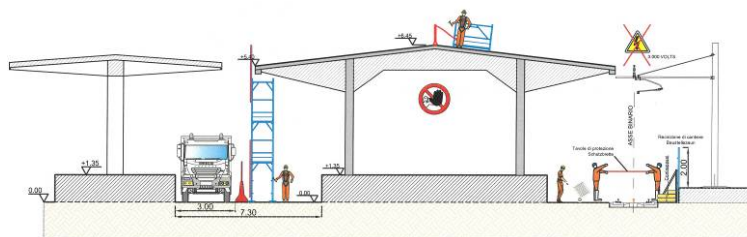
Sezione Demolizione Edificio A9 – Ponteggio/scala – Linea vita – Protezione binario – Recinzione marciapiede
